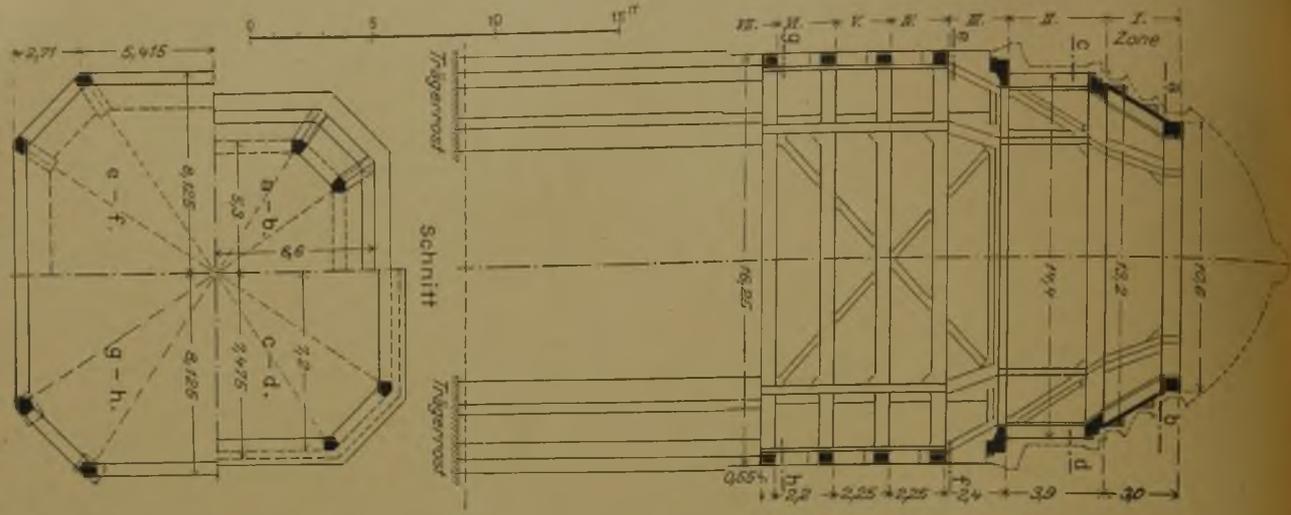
Schnitt u. Grundrisse des Kuppelrumpes.
